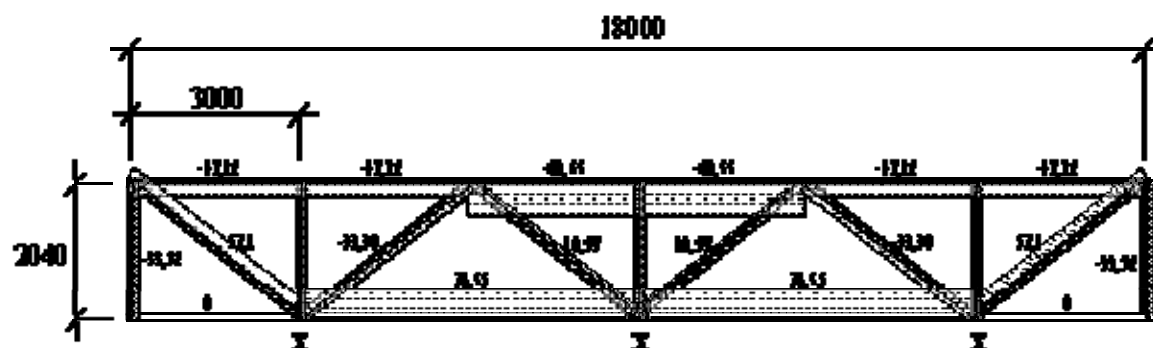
Схема и эпюры усилий железобетонной фермы при равномерно распределенной нагрузке 5,50 кПа
